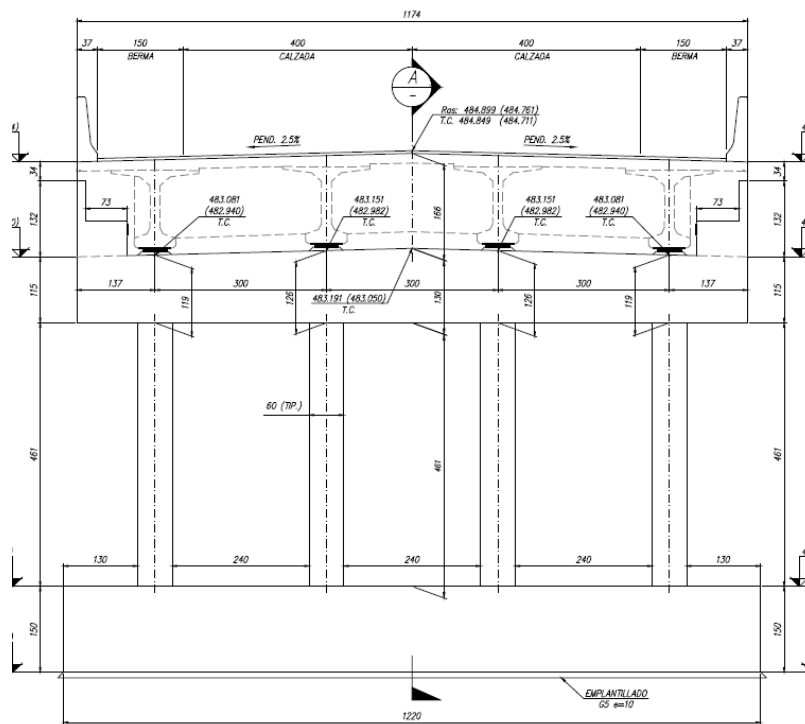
Vista en corte cepa y estribo de Puente San Pablo Antiguo. Fuente: Planos de Proyecto.
